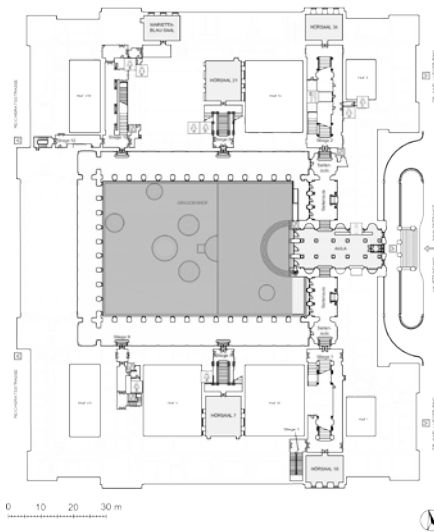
Universität Wien Veranstaltungsmanagement; Grundriss Hauptuni
